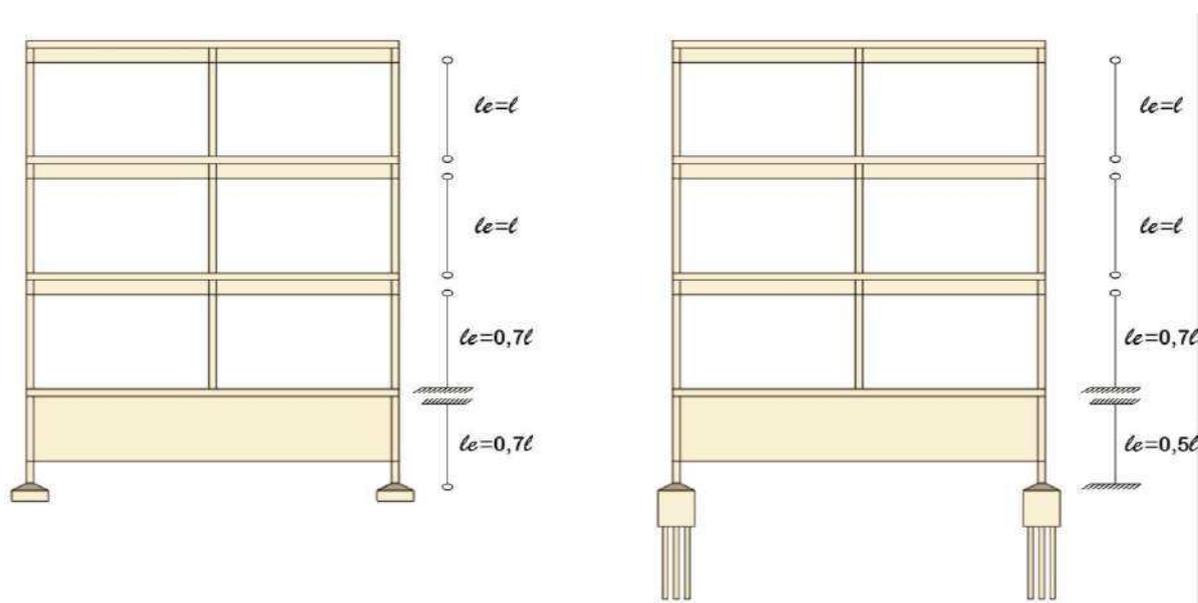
Tipos de apoio dos pilares e comprimento de flambagem.
